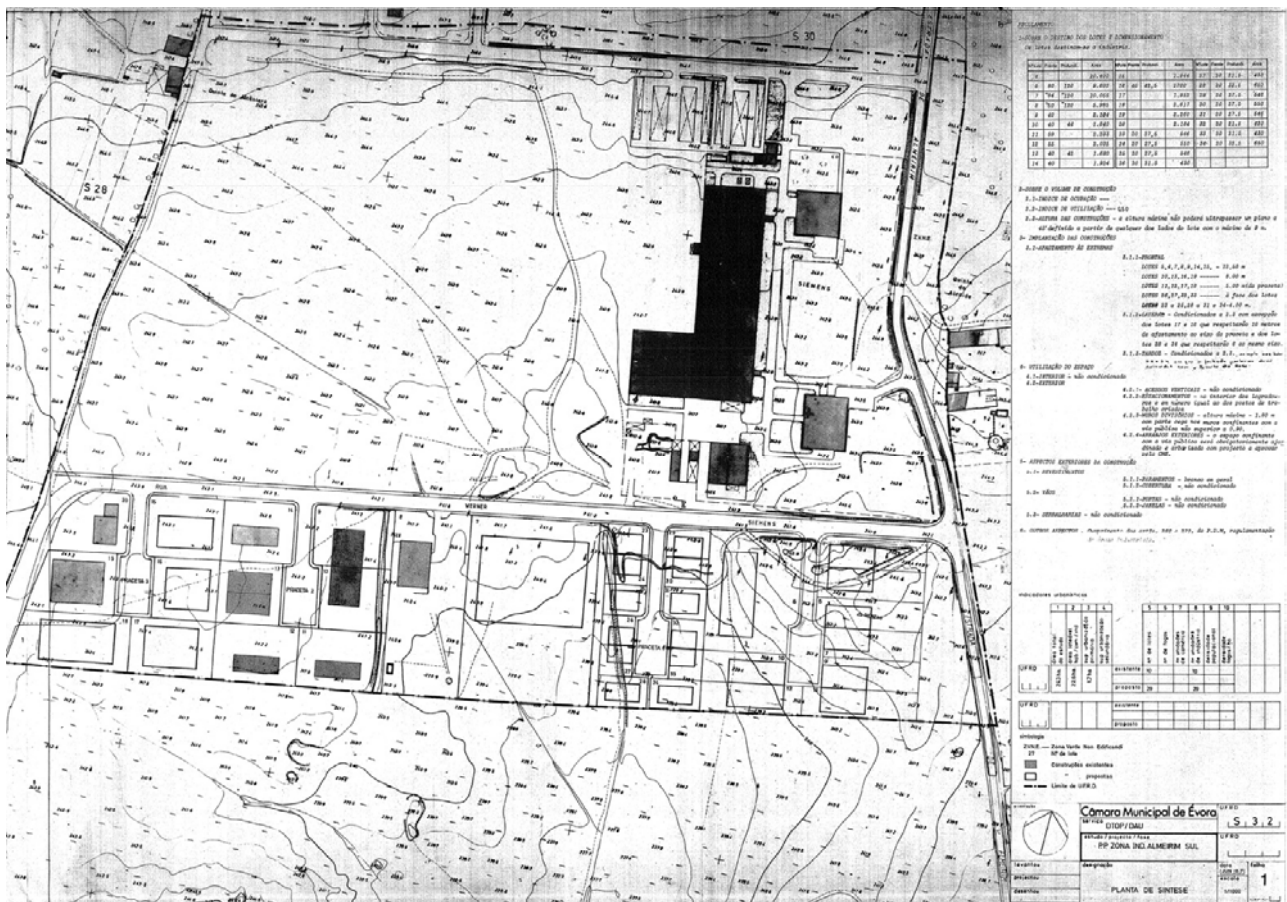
Plano de Pormenor da Zona Industrial de Almeirim Sul (fonte: CME)
